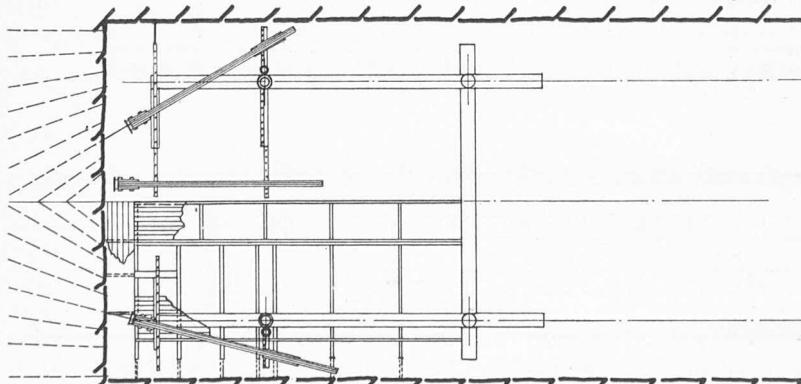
Anordnung der Bohrhämmer und Bohrlöcher. Grundriss 1:220
